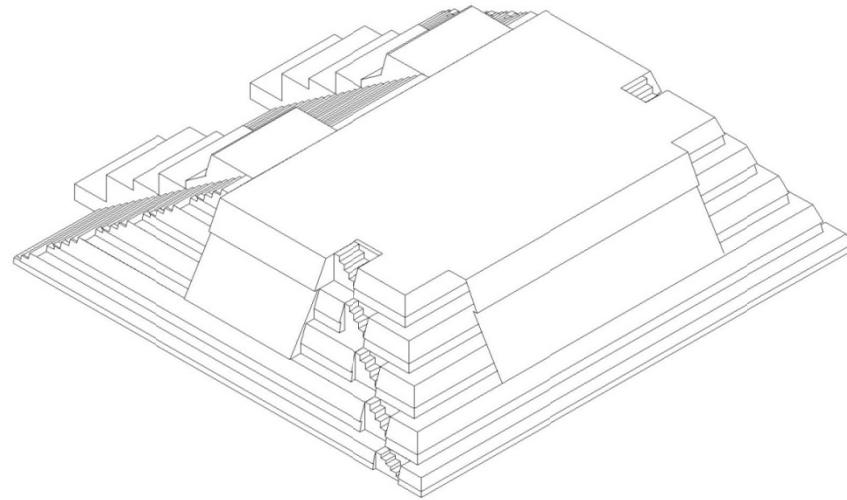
Vista sur oeste, de la subestructura 1, del edificio 144
